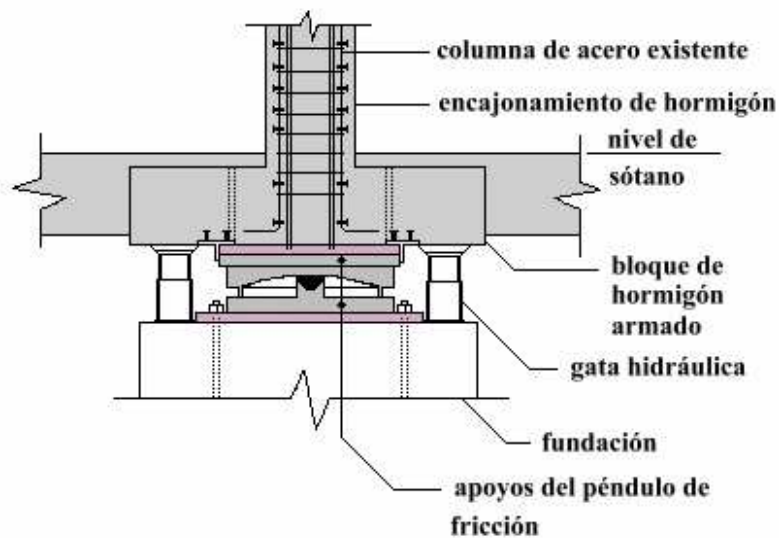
Detalle de instalación del apoyo FPS bajo una columna interior.
